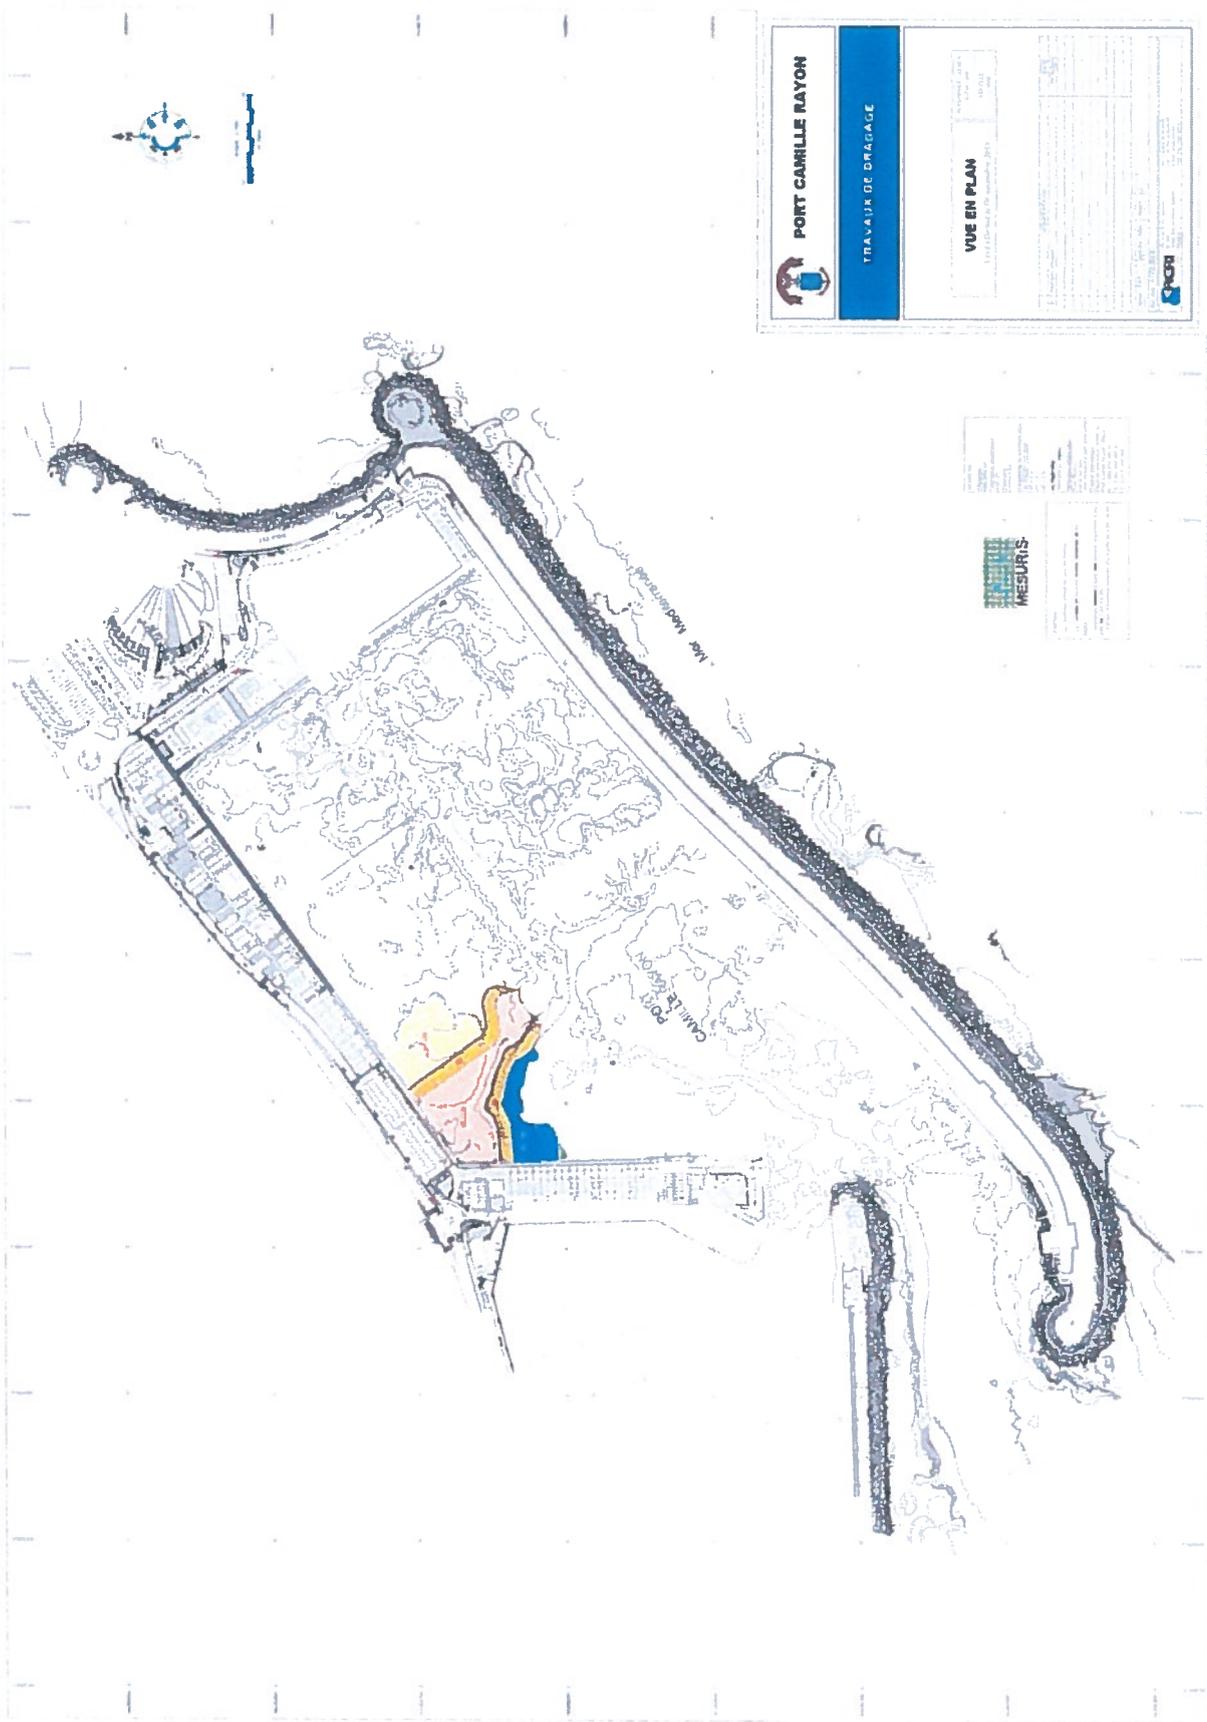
Plan projet des travaux de dragage dans le port de Camille Rayon
